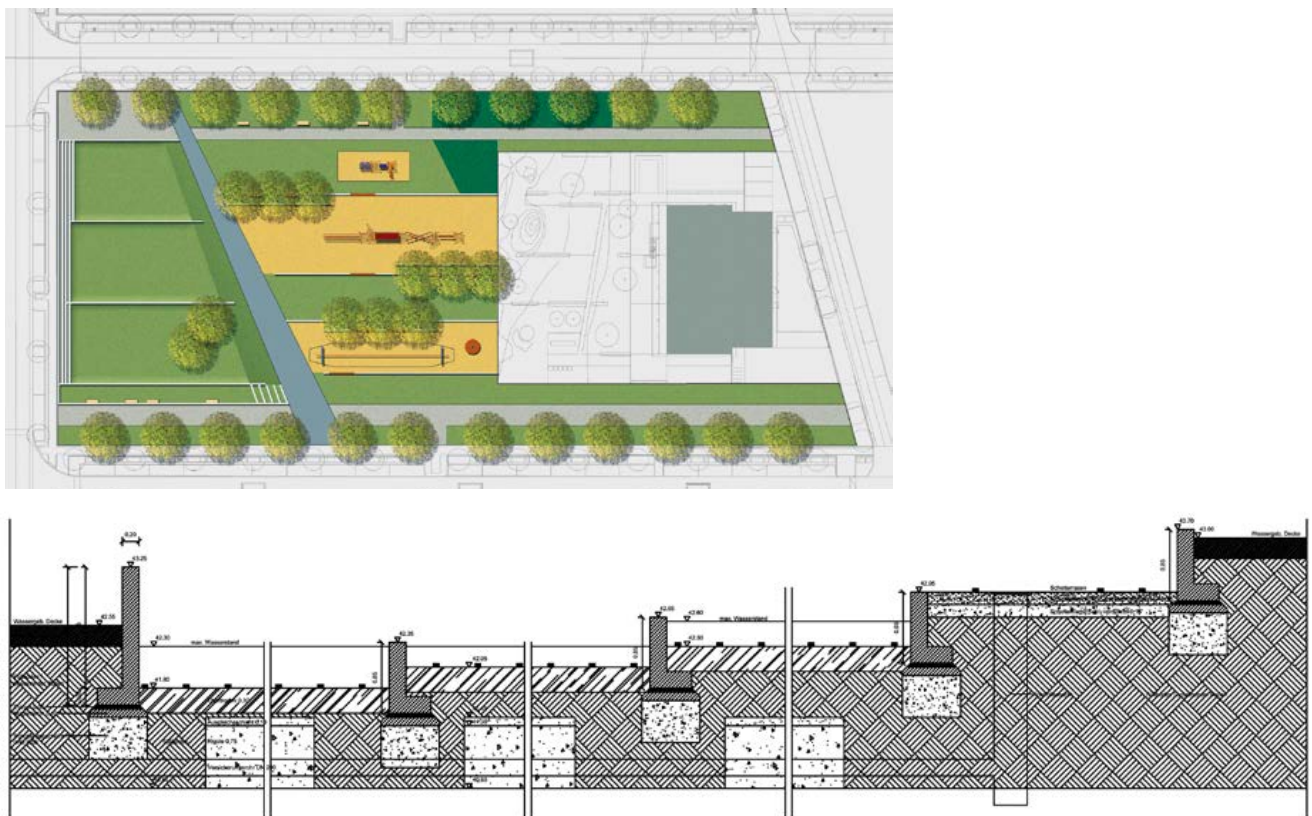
/ b: Südliche Gartenstadt – Lageplan und Systemschnitt Retentionsbecken in der öffentlichen Grünfläche (Entwurf und Ausführungsplanung bgmr Landschaftsarchitekten, 2001)
